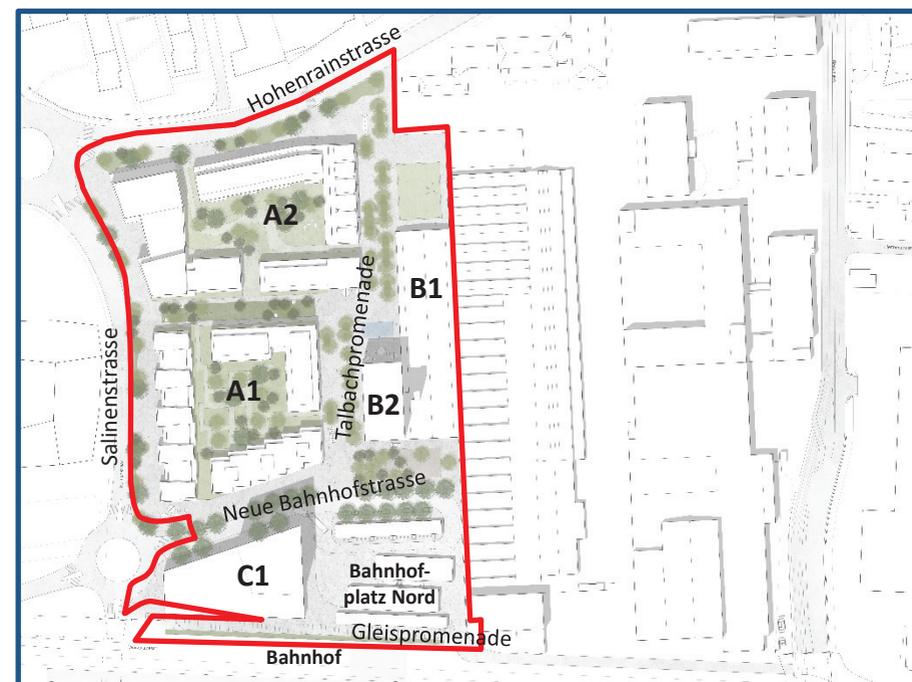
Umsetzung im Quartierplanperimeter Bredella West / rot umrandet: Perimeter QP Bredella West / A1: Baubereich mit begrüntem Innenhof / A2: Baubereich mit begrüntem Innenhof / B1: Umgenutzte Industriehalle / B2: kleineres Hochhaus / C1: Hochhaus mit Supermarkt
